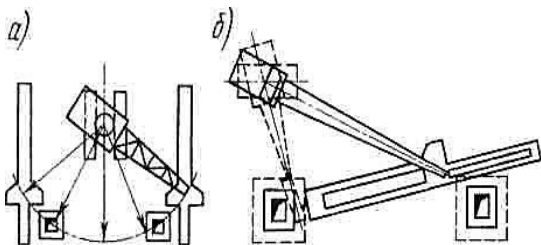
Способы подъема железобетонных колонн: а – легких; б – тяжелых
